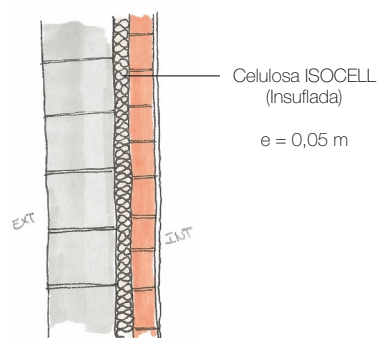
Pared frontal (Sur) y trasera (Norte), con aislamiento inyectado en cámara de aire (autoría propia).
